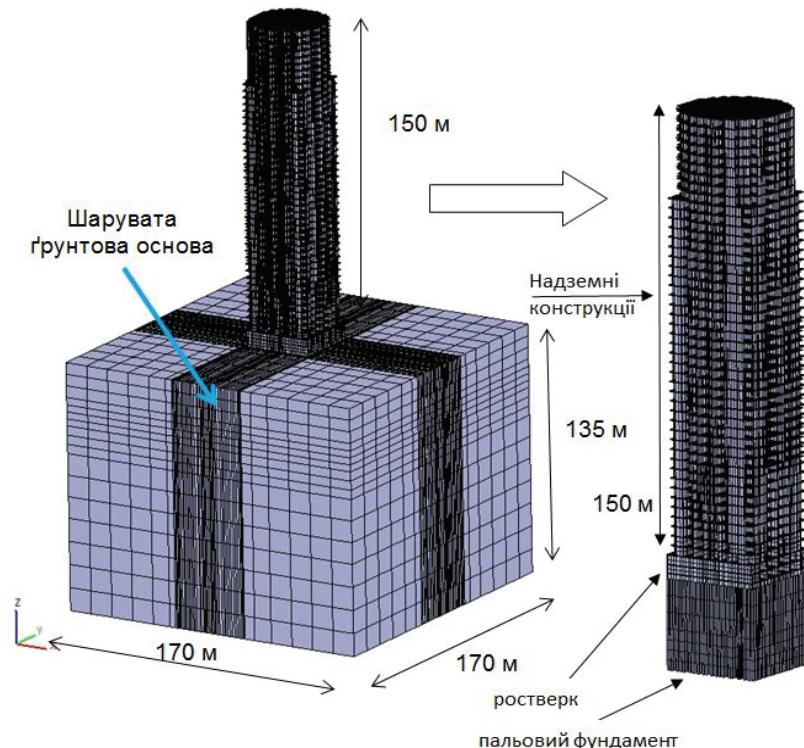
Скінченно-елементна модель системи «основа—фундамент—будівля»
